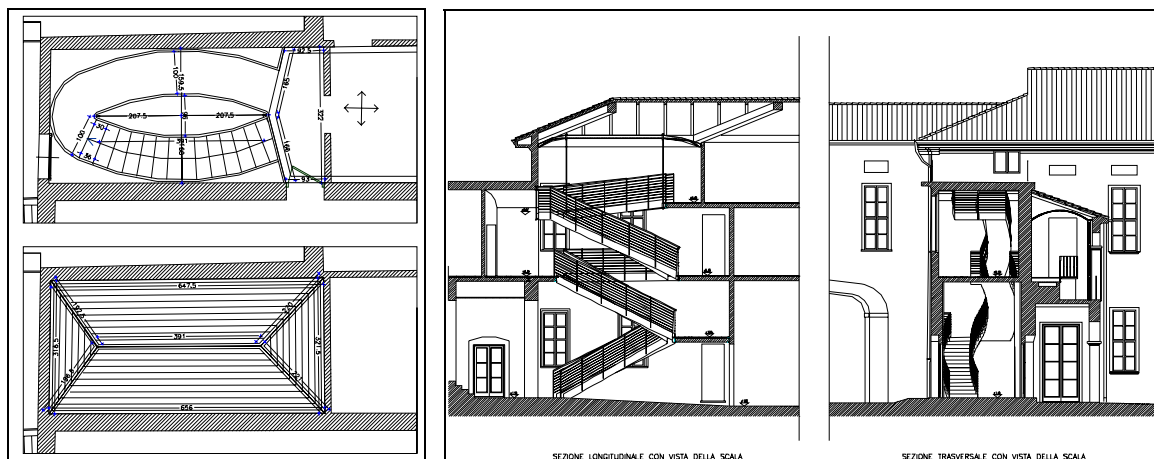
Nuova scala in acciaio con rampe curvilinee. a) pianta della scala e della struttura voltata in acciaio posta in sommità; b) sezione longitudinale.
